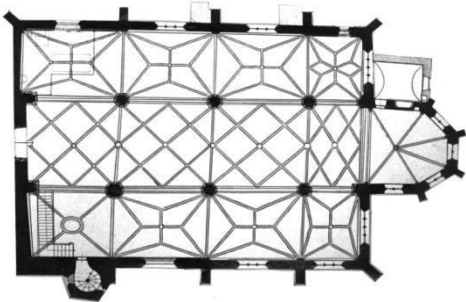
Steinborn, St. Lambertus, Grundriss
